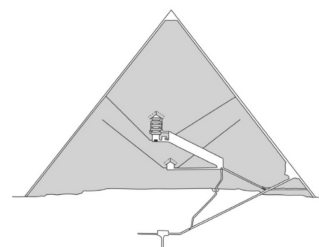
Sección por la Gran Galería de la pirámide de Keops en Giza. Modificado de F. Monnier (2011, p. 94).
